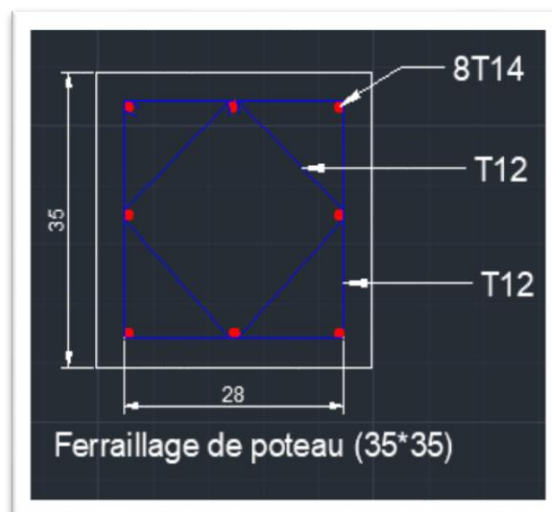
Schéma du ferrailage du poteau (35x35) cm du bloc A
